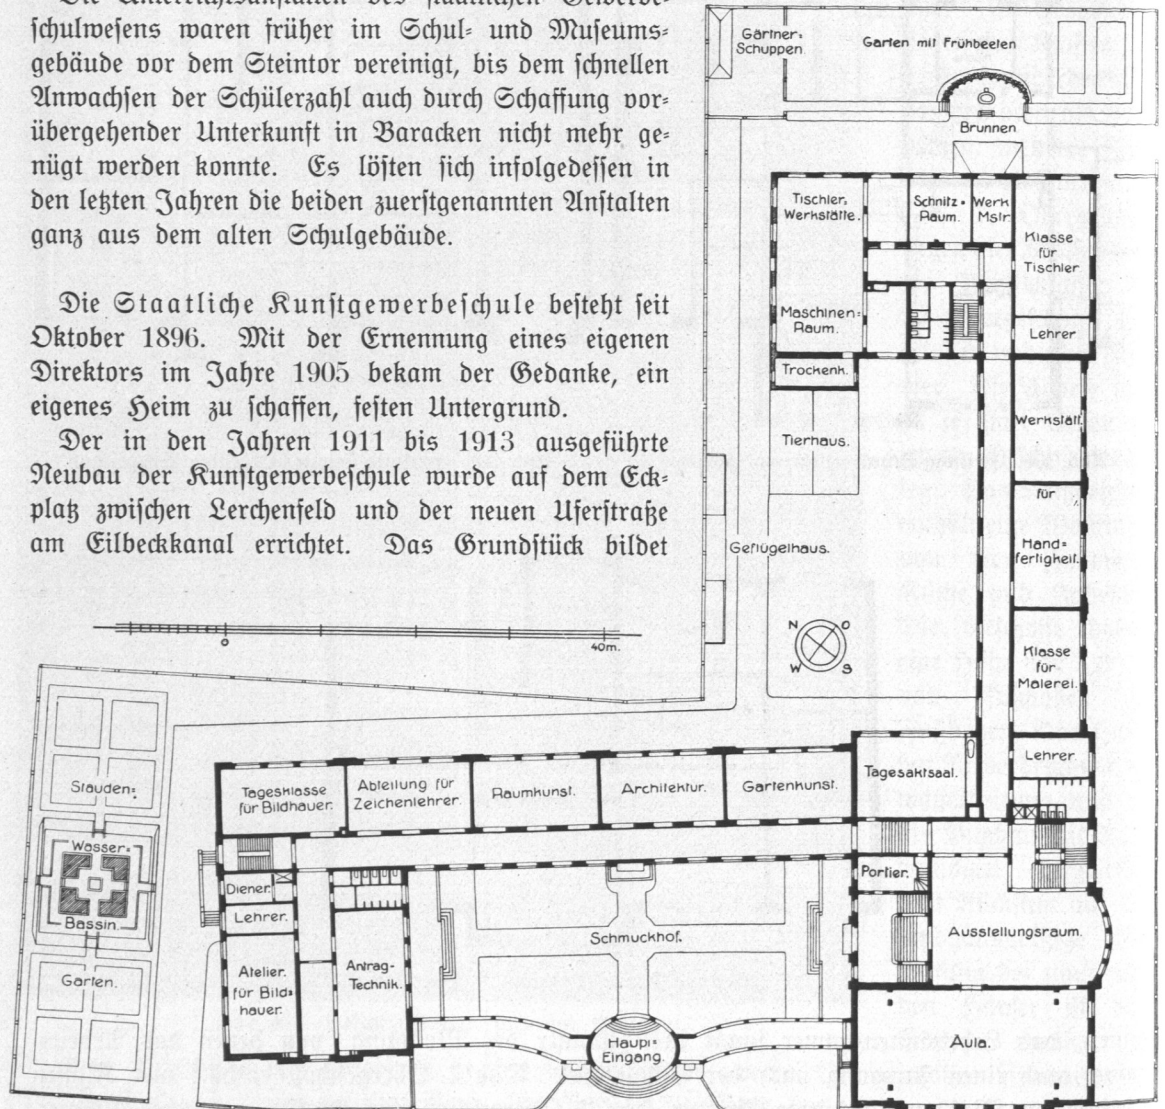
Staatliche Kunstgewerbeschule, Erdgeschoß, Grundriß.
